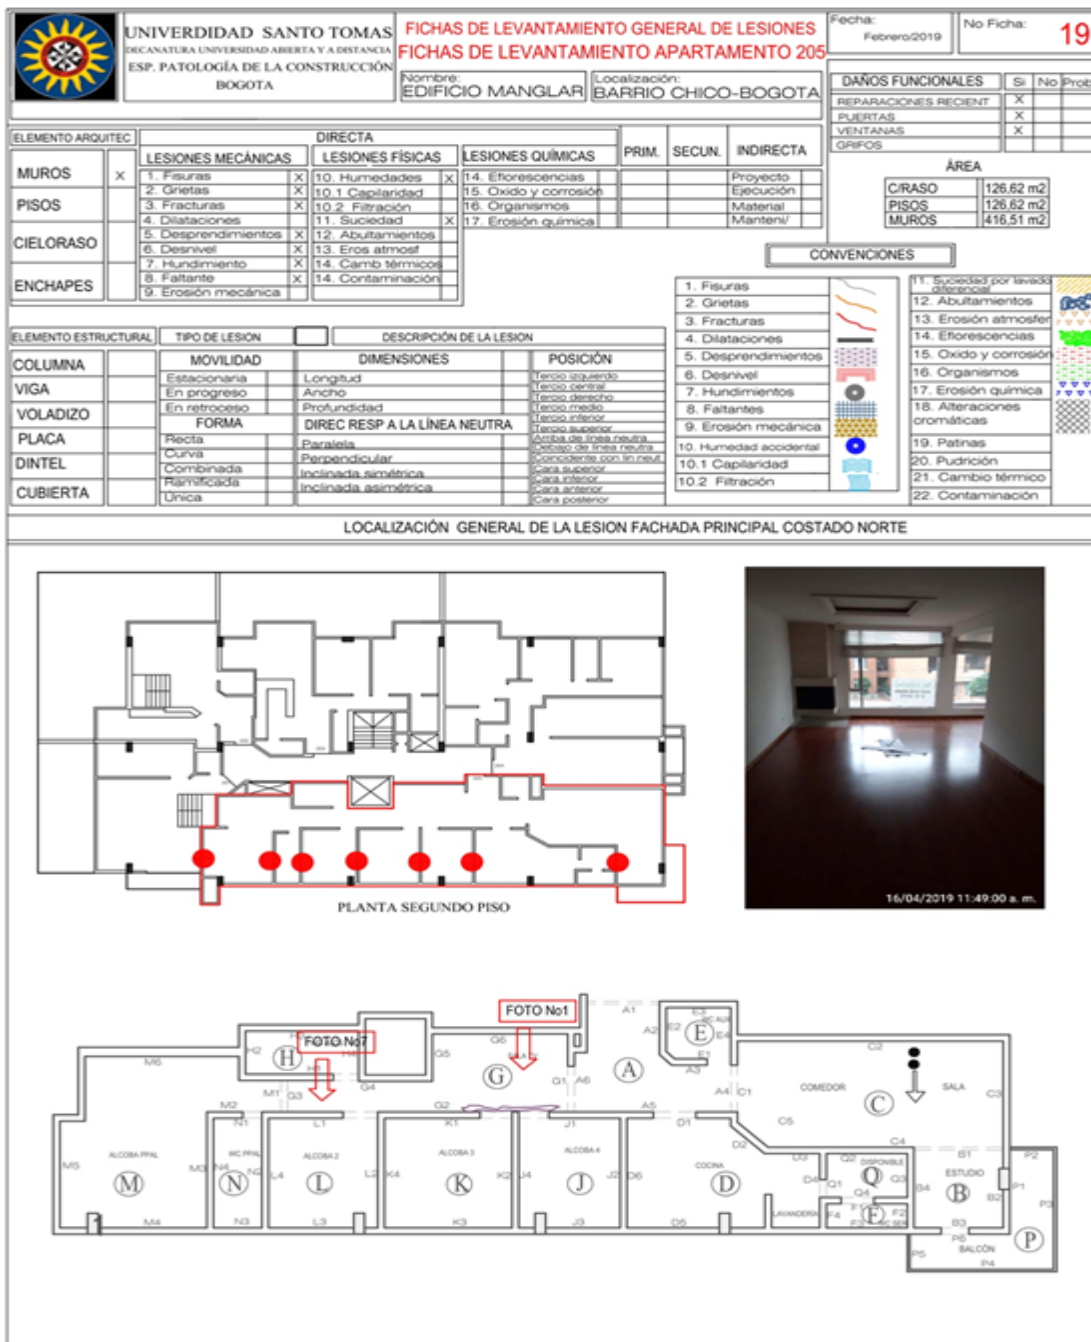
Ficha Levantamiento de Daños Apartamento 205. Fuente: Elaboración propia
